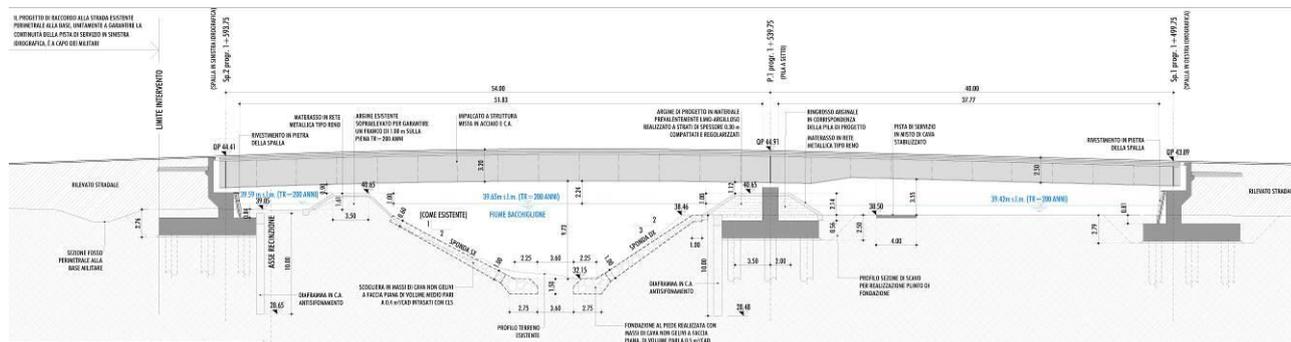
SEZIONE LONGITUDINALE PONTE SUL FIUME BACCHIGLIONE
